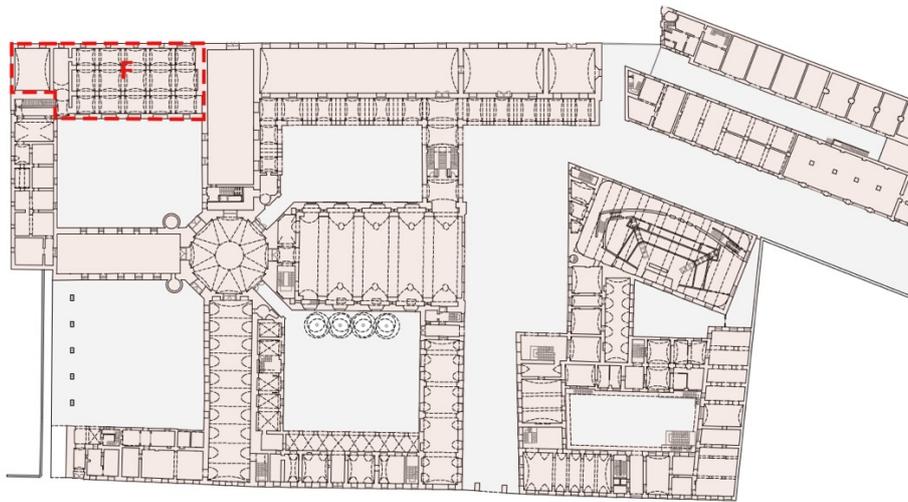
planimetria con evidenza edificio F - elaborazione personale
